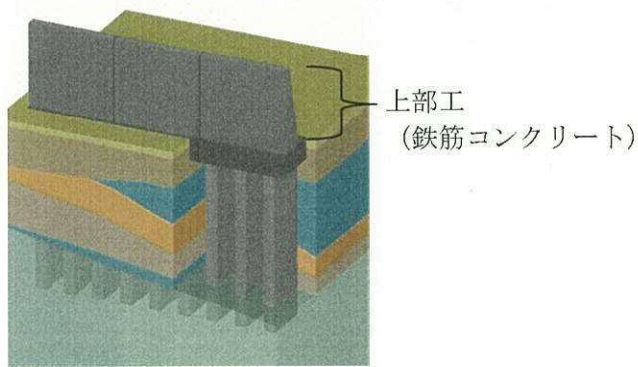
鉄筋コンクリート防潮壁の上部工
